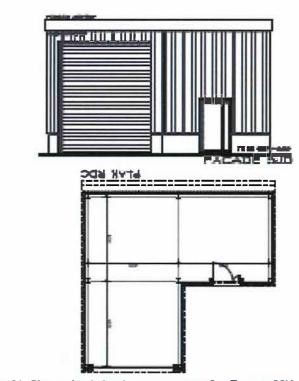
Plan projet du local garage, source : Cap Terre et CCV
